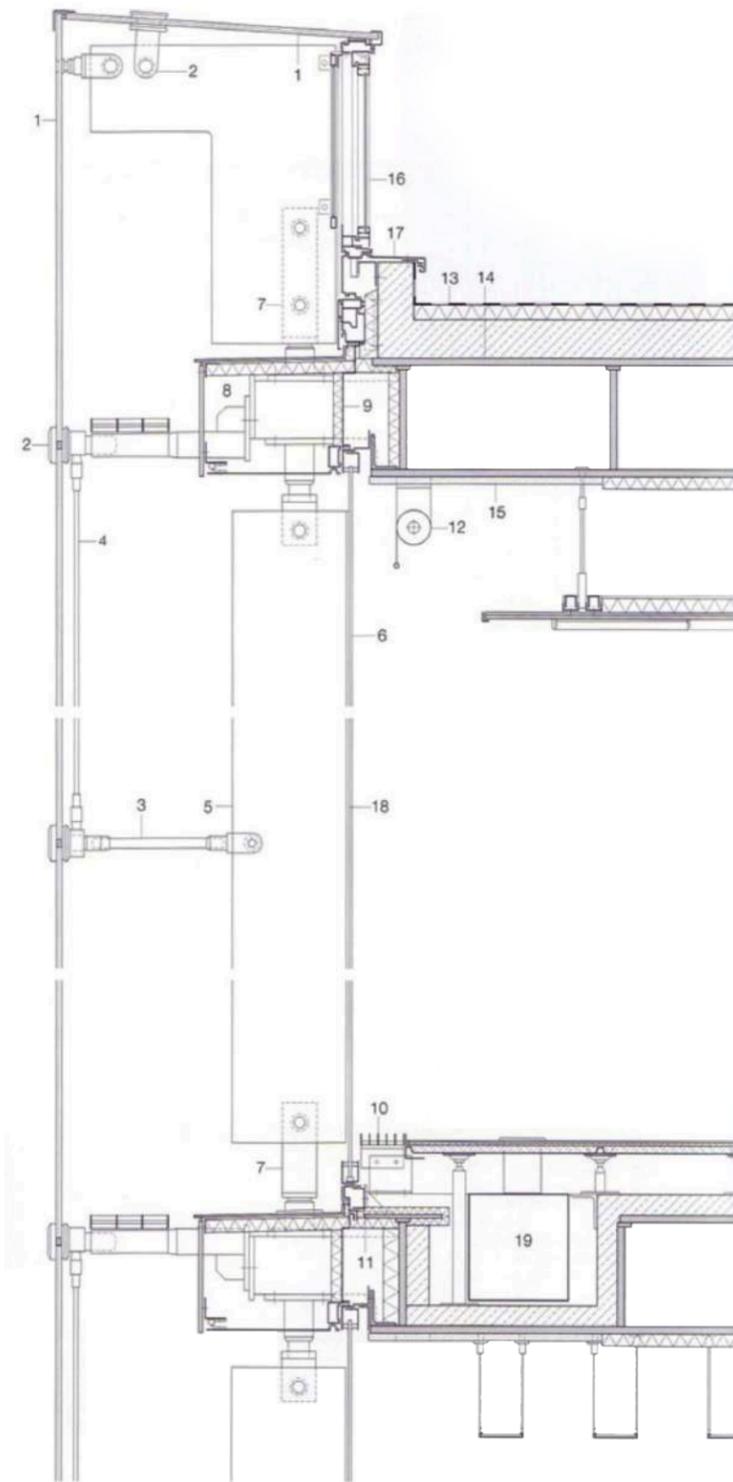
Détail d'assemblage du plancher et de l'enveloppe [Details, 2011]
